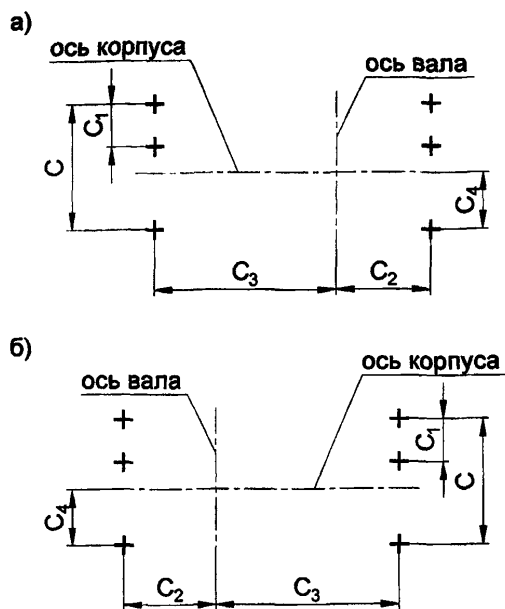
План расположения отверстий для крепления вентиляторов ВР80-75-2,5 - ВР80-75-12,5 (исполнения 1 и 5) с виброизоляторами к поддерживающей конструкции:
